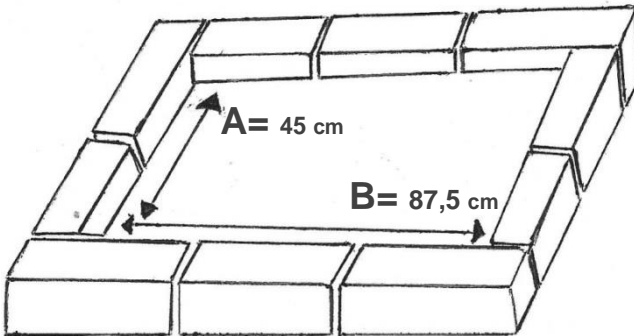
Schéma de coffrage d'une dallette de défécation avec des parpaings
